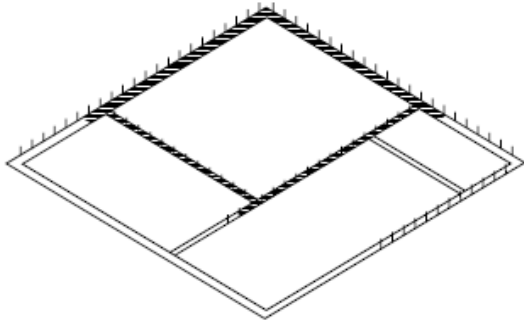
1. Distribución y emplazamiento de barras de ensamblaje
